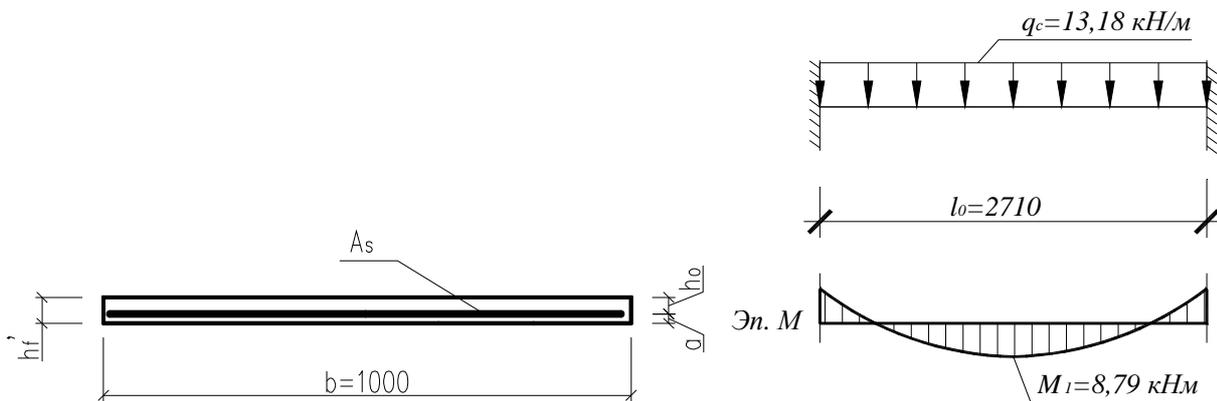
Приведенное сечение полки плиты, расчетная схема и эпюра момента
